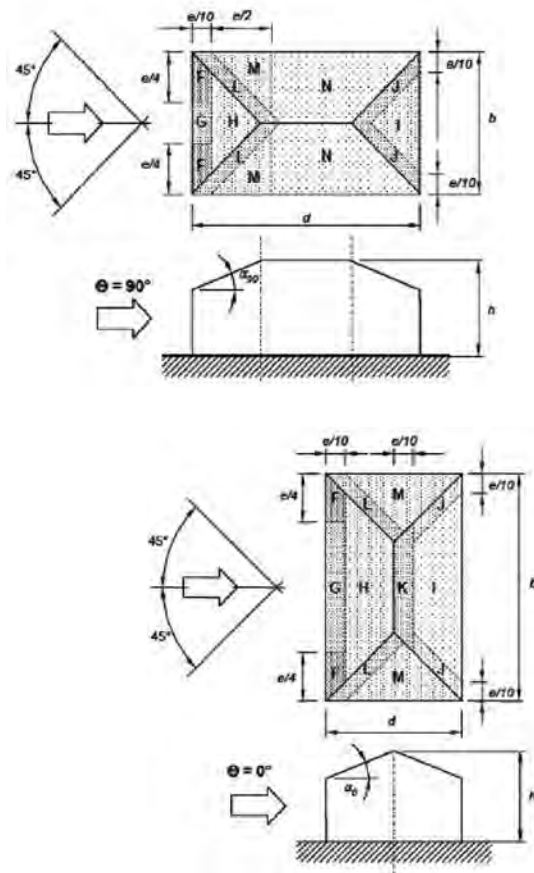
Suddivisione delle coperture a padiglione in zone di uguale pressione
